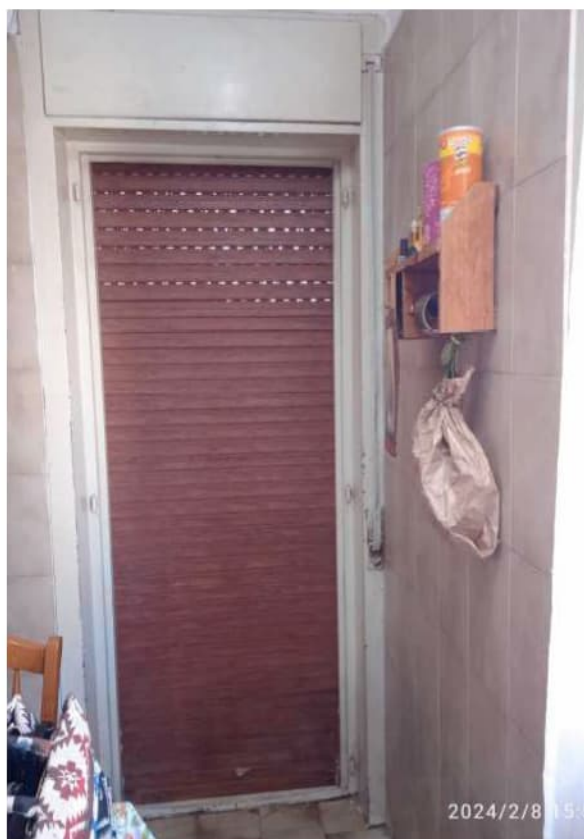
L'infisso esterno sprovvisto dell'anta interna.
